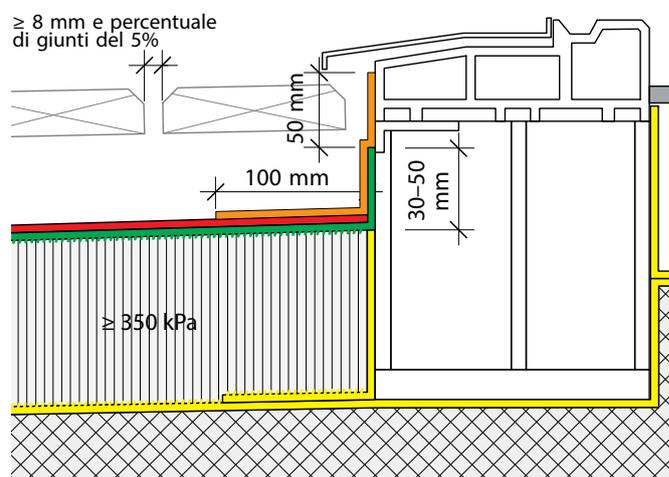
impermeabilizzazione bituminosa con risvolto di resina
